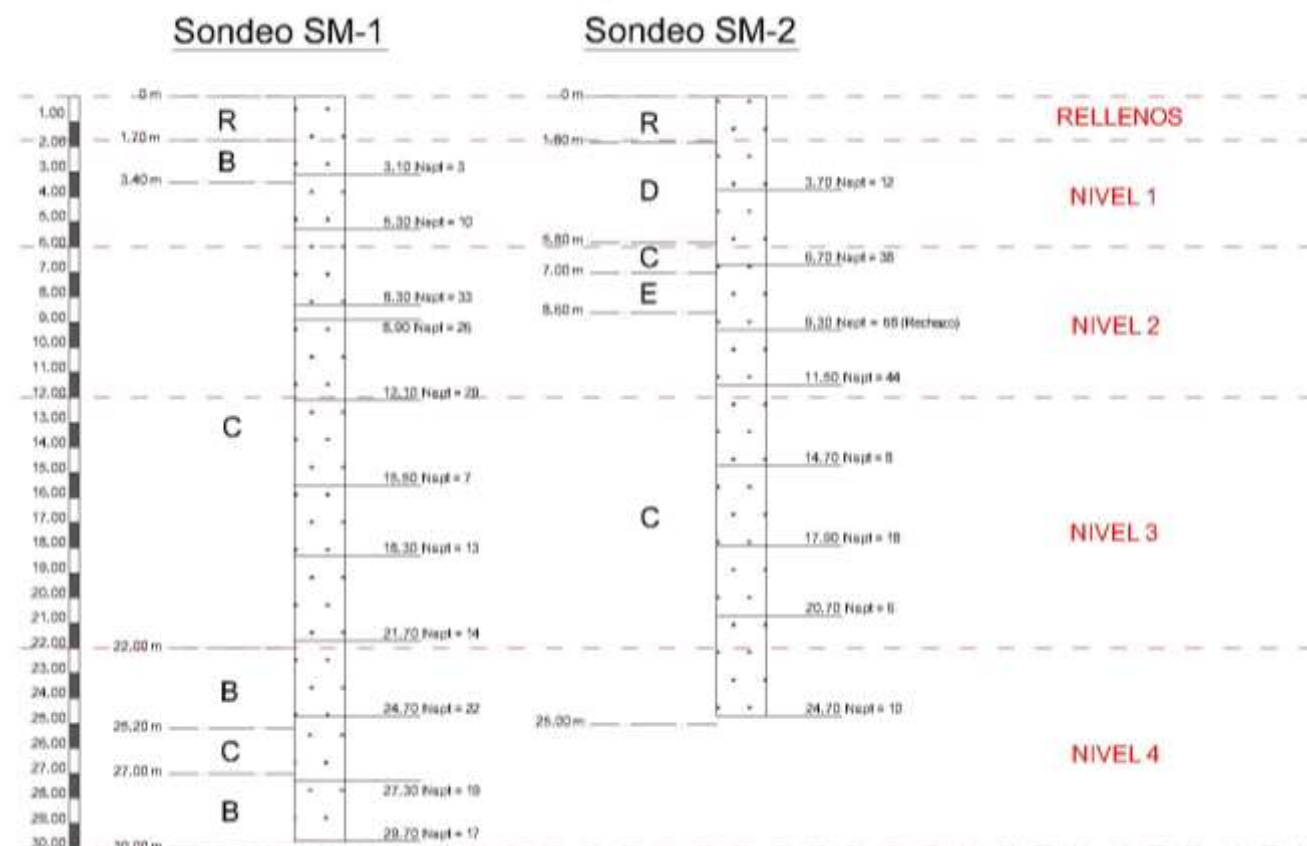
Perfil geotécnico del terreno. Fuente: Elaboración propia mediante AutoCAD.
